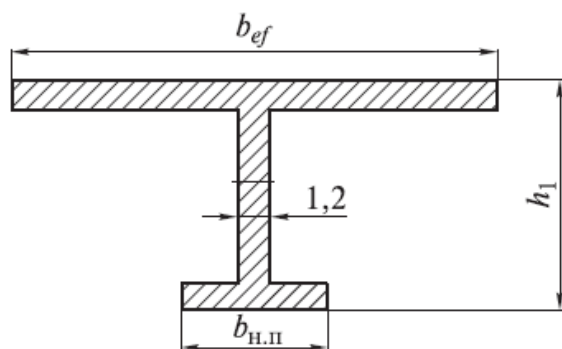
Искомая форма поперечного сечения поперечного ребра
